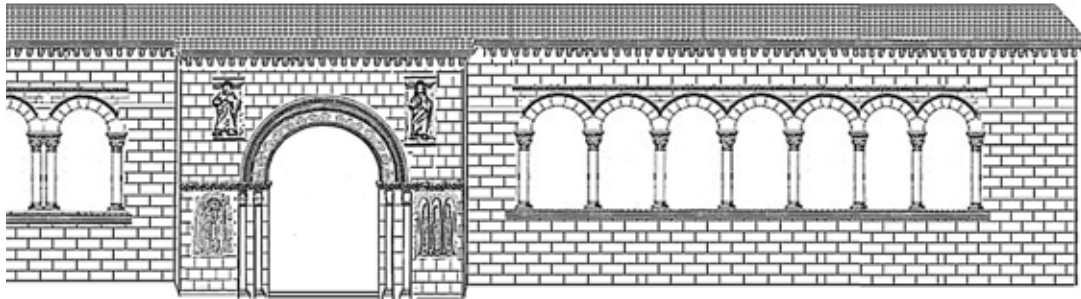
Propuesta de reconstrucción de la galería porticada (Dibujo del autor)
